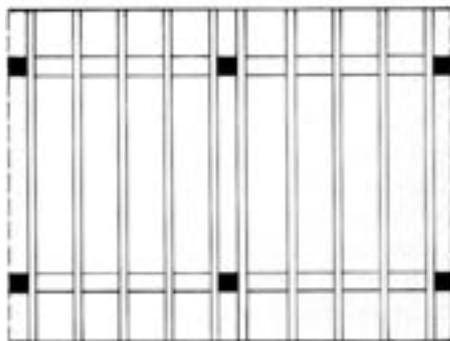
Planta baixa com os pilares e o sistema de suporte temporário. [FRAMPTON, 1979]:69c
